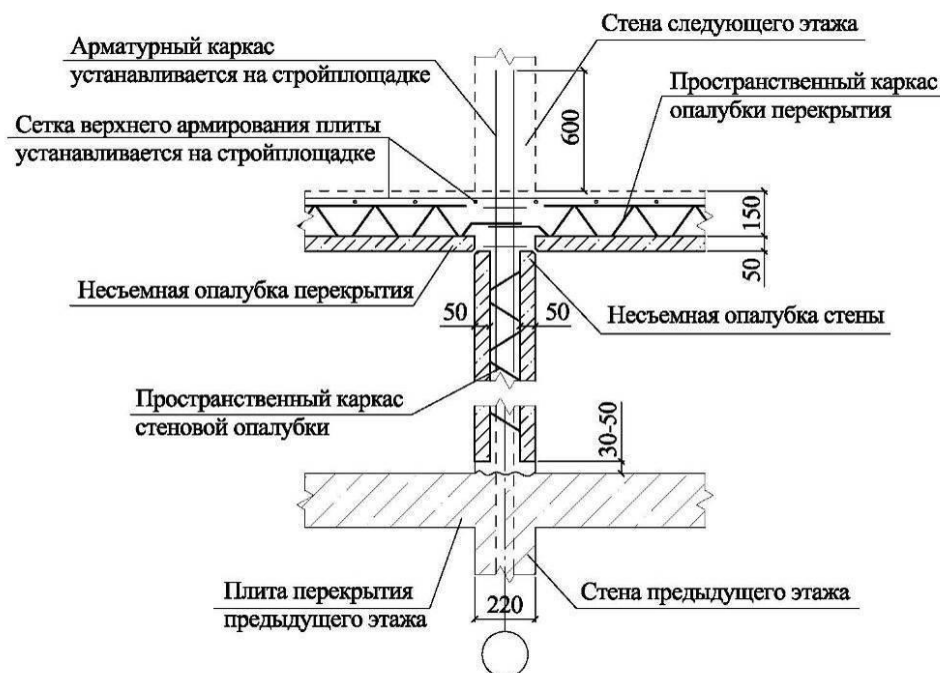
Монтаж стеновых конструкций и перекрытий при внедрении несъемной опалубки
